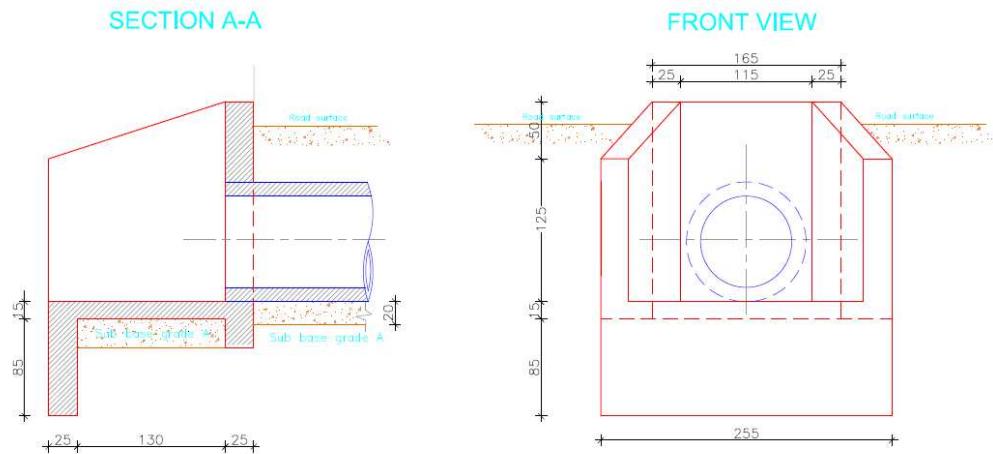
Vista de tubo de alcantarilla de Ø 80, sobre la Quebrada Cañazas
